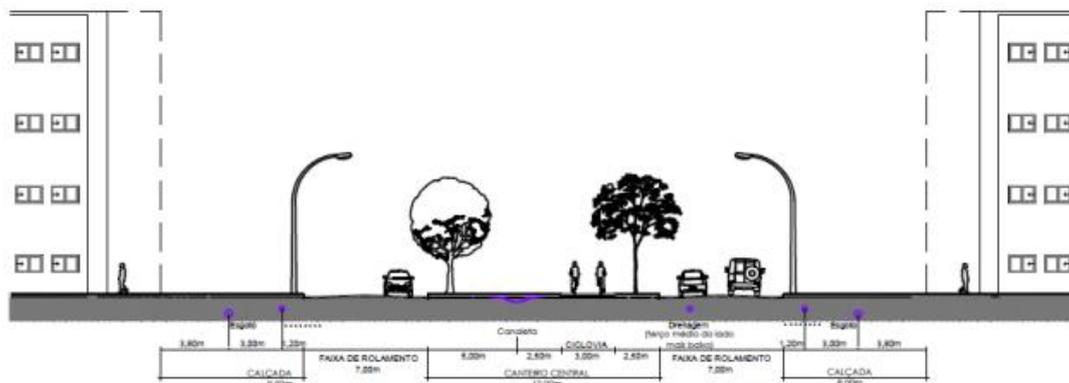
Perfil de via arterial sentido oeste-leste.
